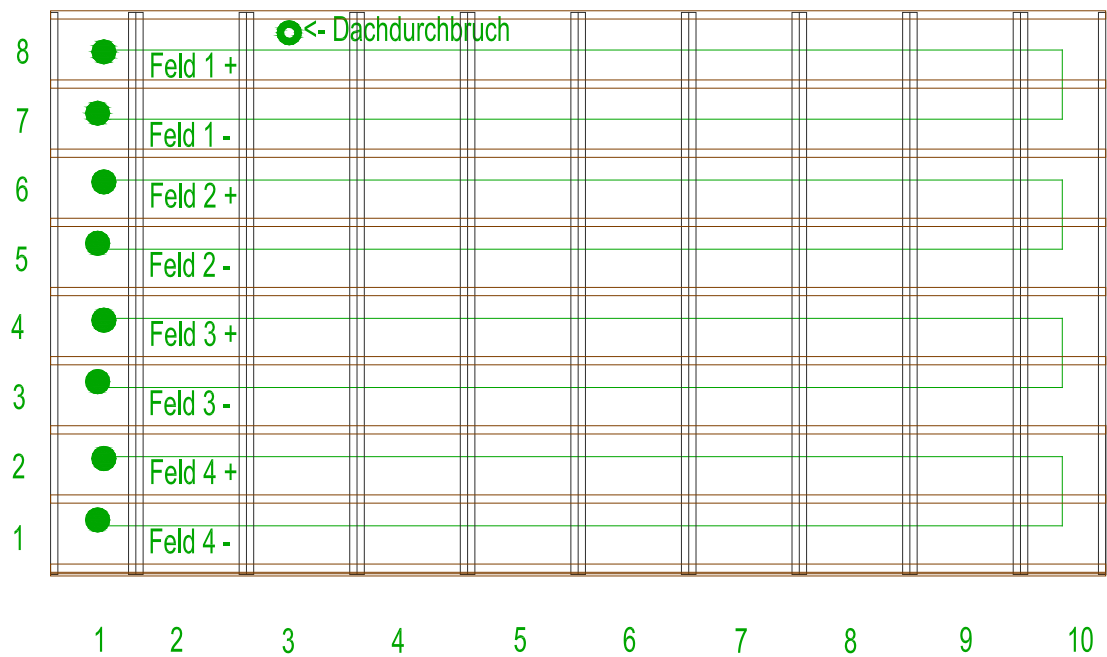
Exemple de plan de câblage; version câblage « horizontale »
